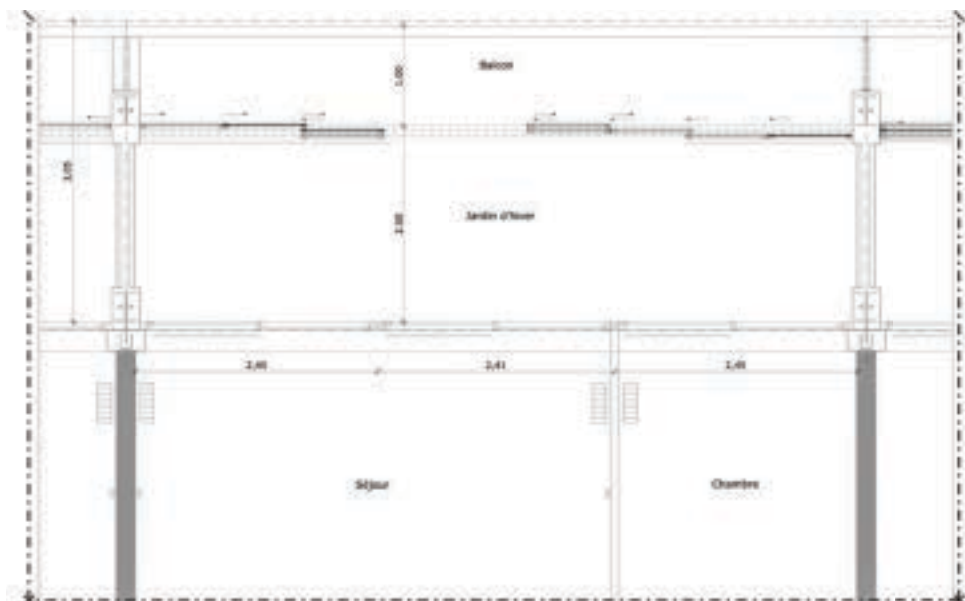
Planta de um módulo prefabricado, após a sua instalação na torre. (Lacaton & Vassal, 2015, p. 234)
